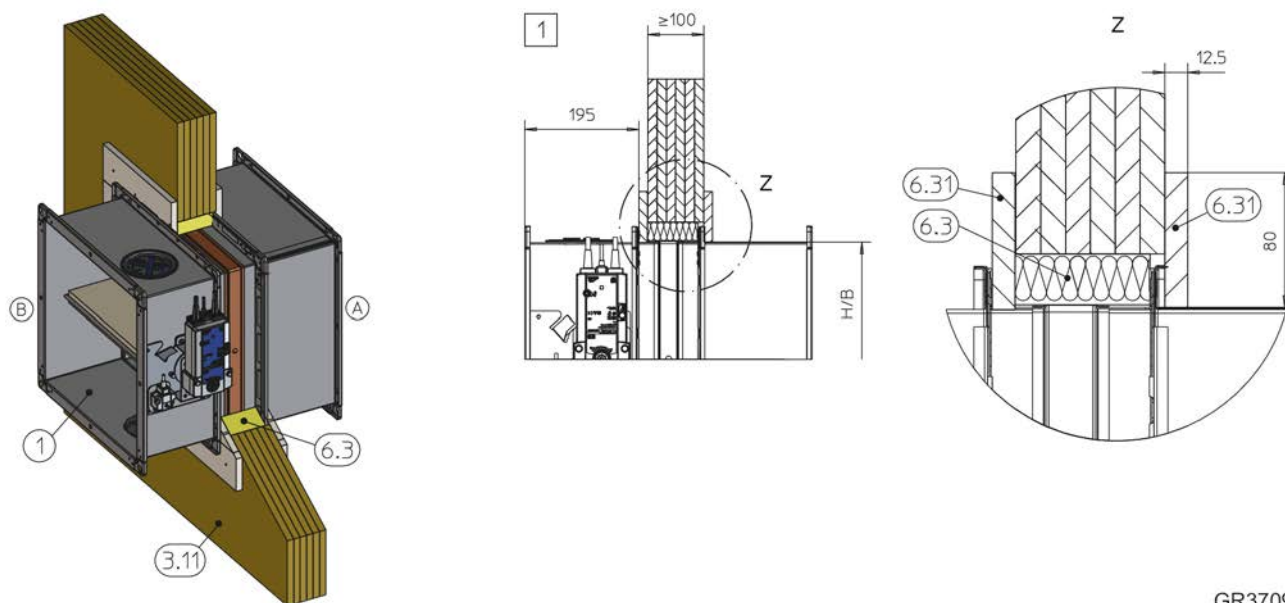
Installazione senza muratura in una parete solida in legno o parete in legno lamellare a strati incrociati, con kit d'installazione ES
